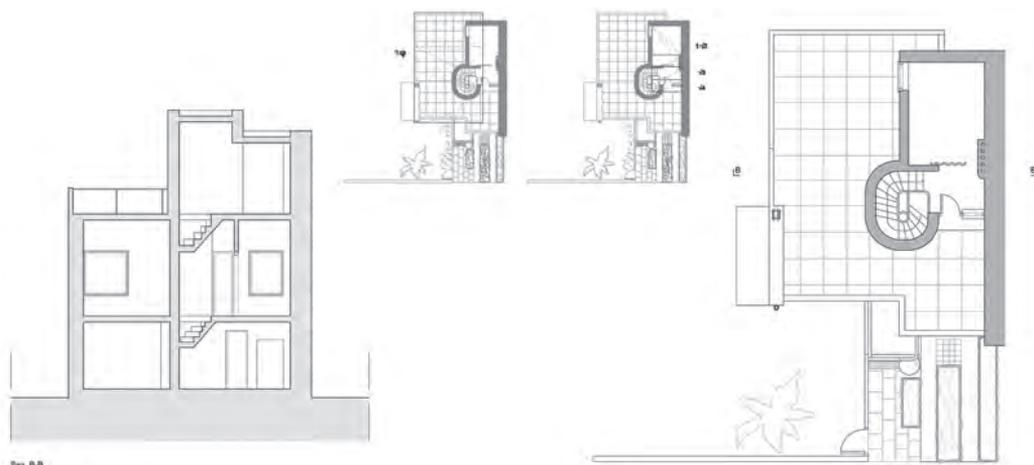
Ridisegno della pianta delle coperture, sezione trasversale e rapporti armonici.
